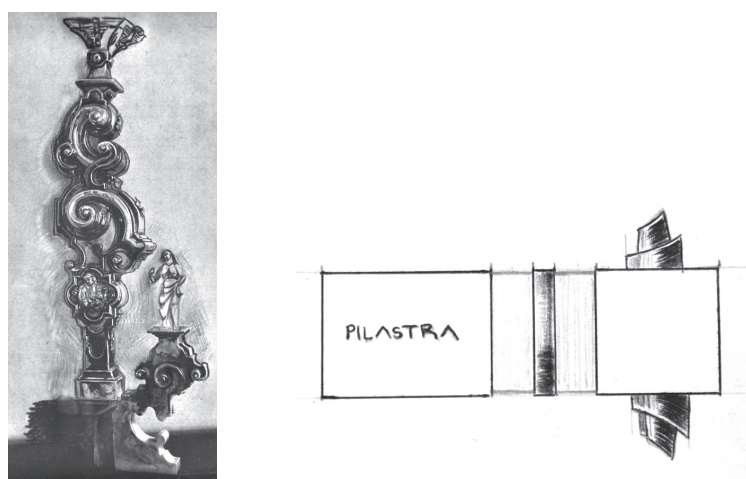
a-b. Alzado y planta de las pilastras del segundo cuerpo. Dibujo Ricardo Cruzaley
